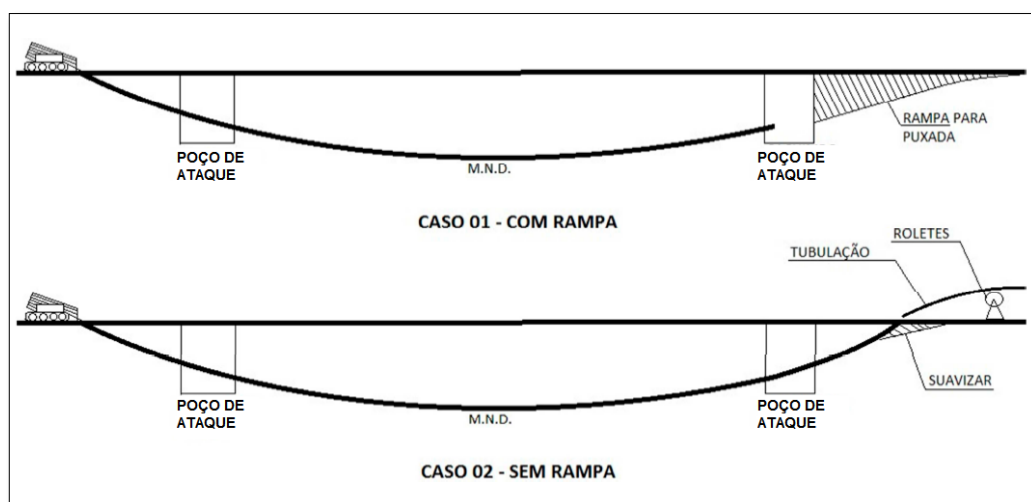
Ilustração de perfil M.N.D. com ou sem rampa
